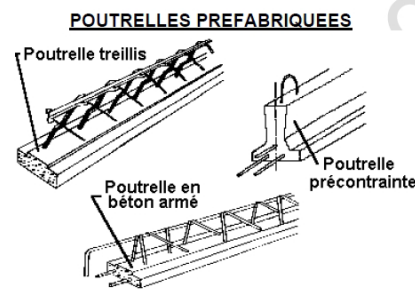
Les différents types de poutrelles pleines (source : KASSOUL.A, cours : bâtiment 2, chapitre 01 : plancher, pp 04).
